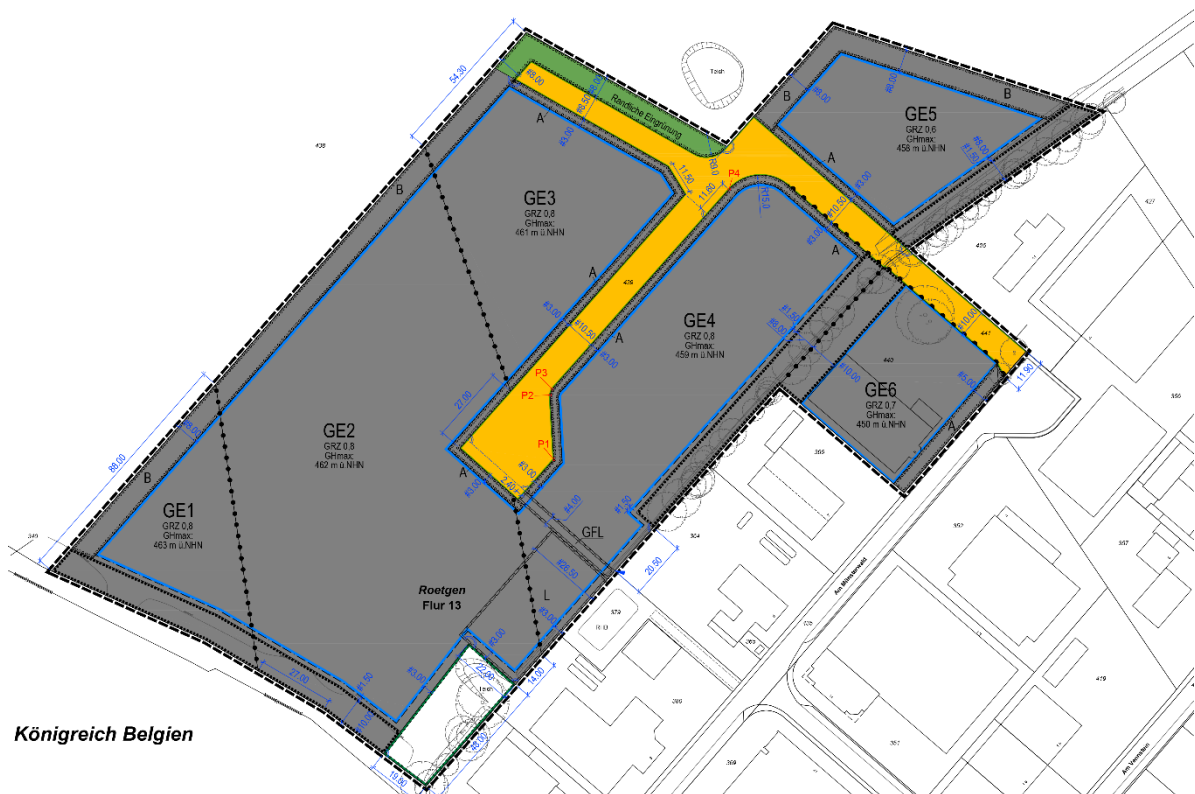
Planzeichnung des Bebauungsplans Nr. 36 ‚Gewerbegebiet Am Vennstein‘
